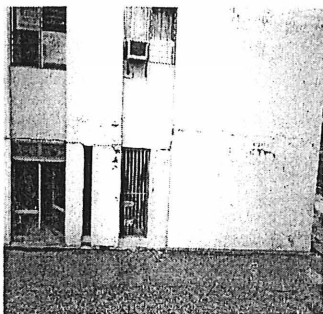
Fissures profondes de béton des murs de façades
